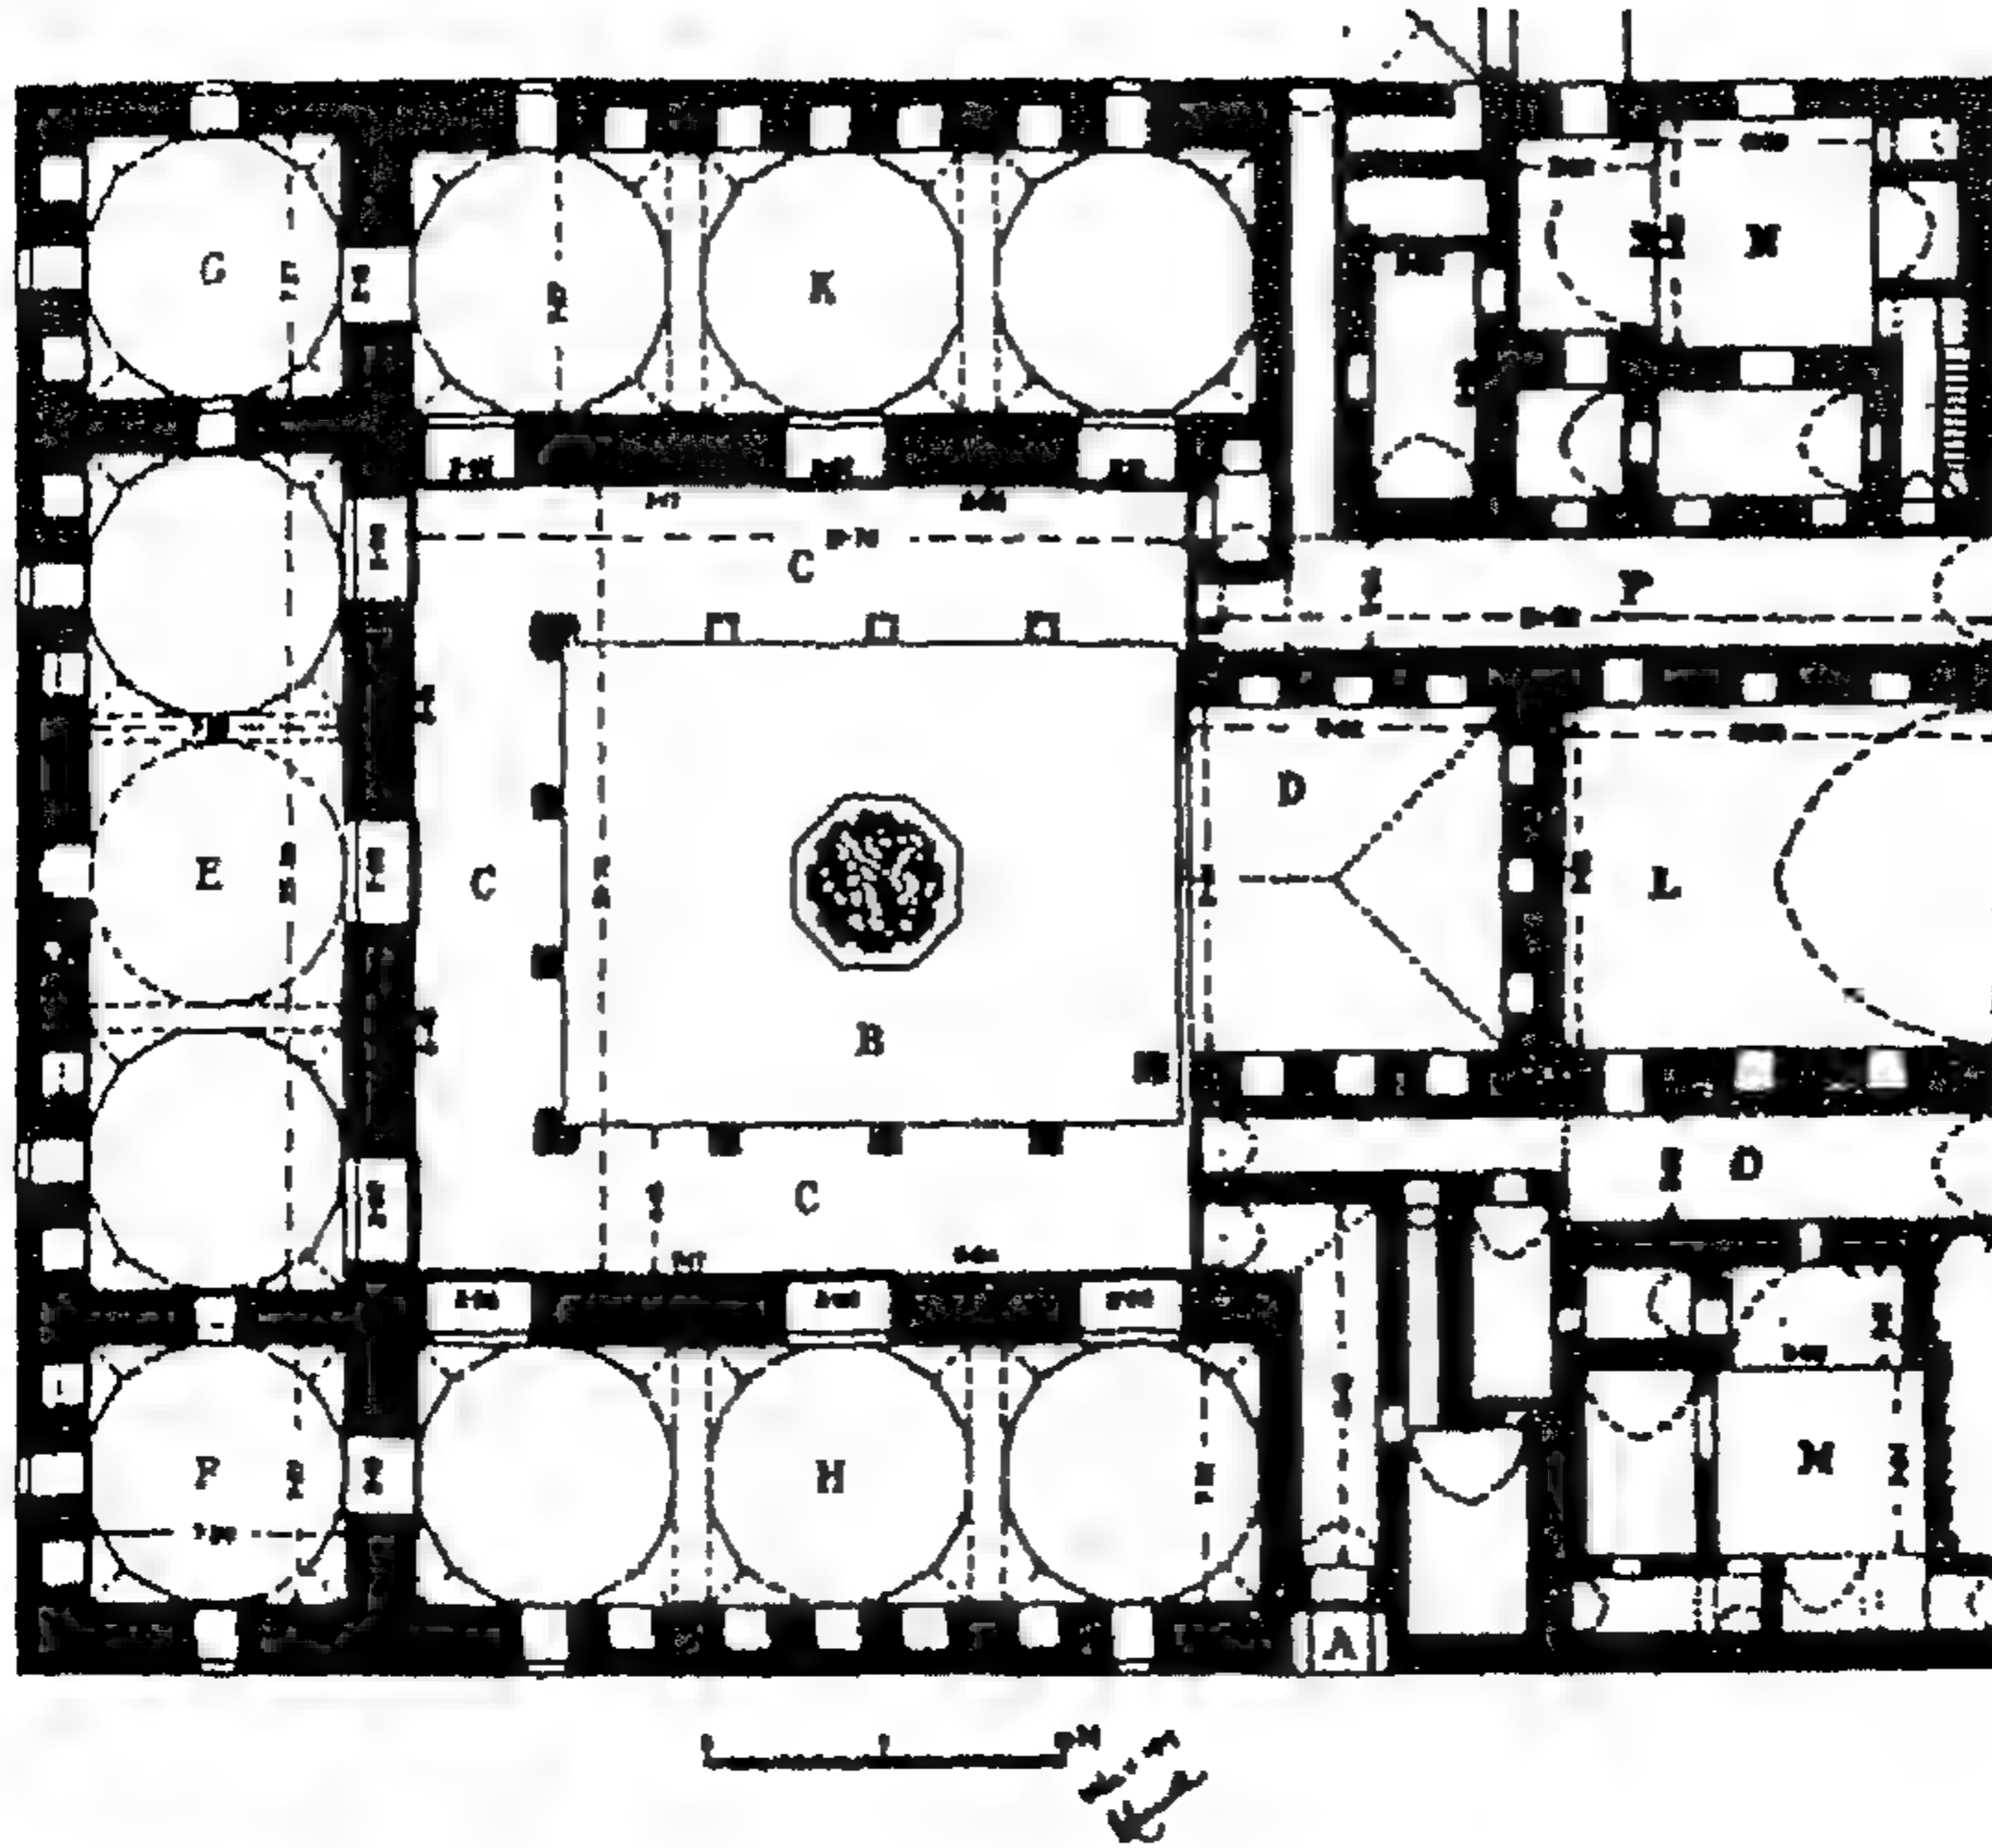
مسقط أفقي لمدرسة كوشتكين في بصري (عن : أصلان آبا) .
